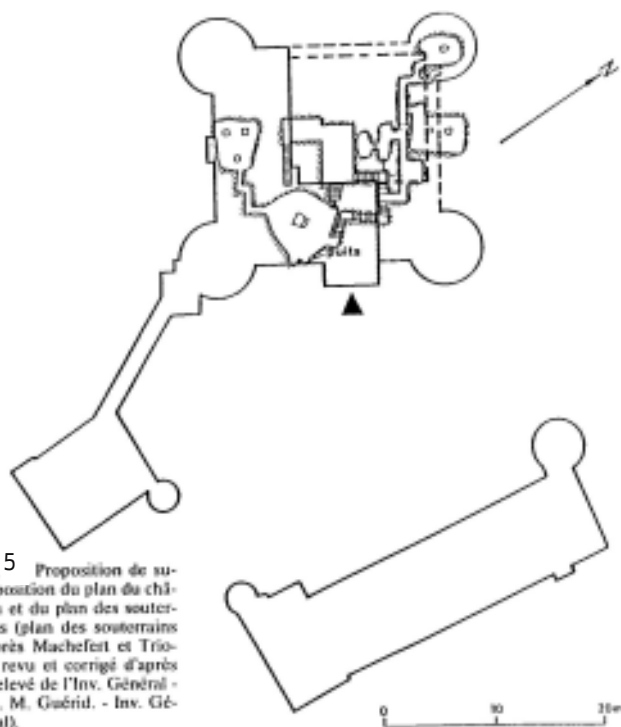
Proposition de superposition du plan du château et du plan des souterrains (plan des souterrains d'après Machefert et Triolet, revu et corrigé d'après le relevé de l'Inv. Général - Del. M. Guérid. - Inv. Général).
